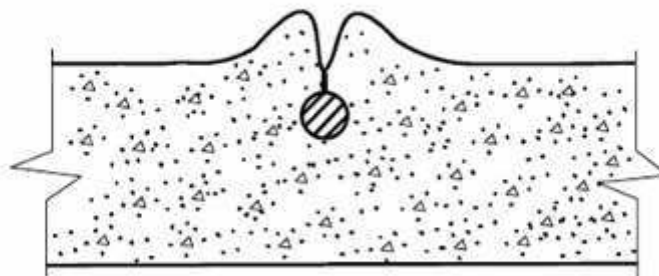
Fissuras de assentamento plástico, fonte DNER 1994
